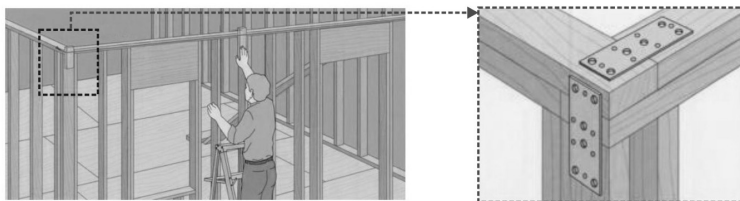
Aplicação de chapas pregadas entre barras superiores e entre barras superiores e montante de canto (adaptado de WAGNER, 2005)
